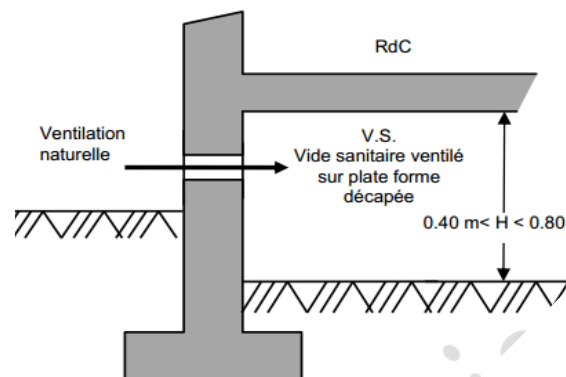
CONSTRUCTION SUR VIDE SANITAIRE
